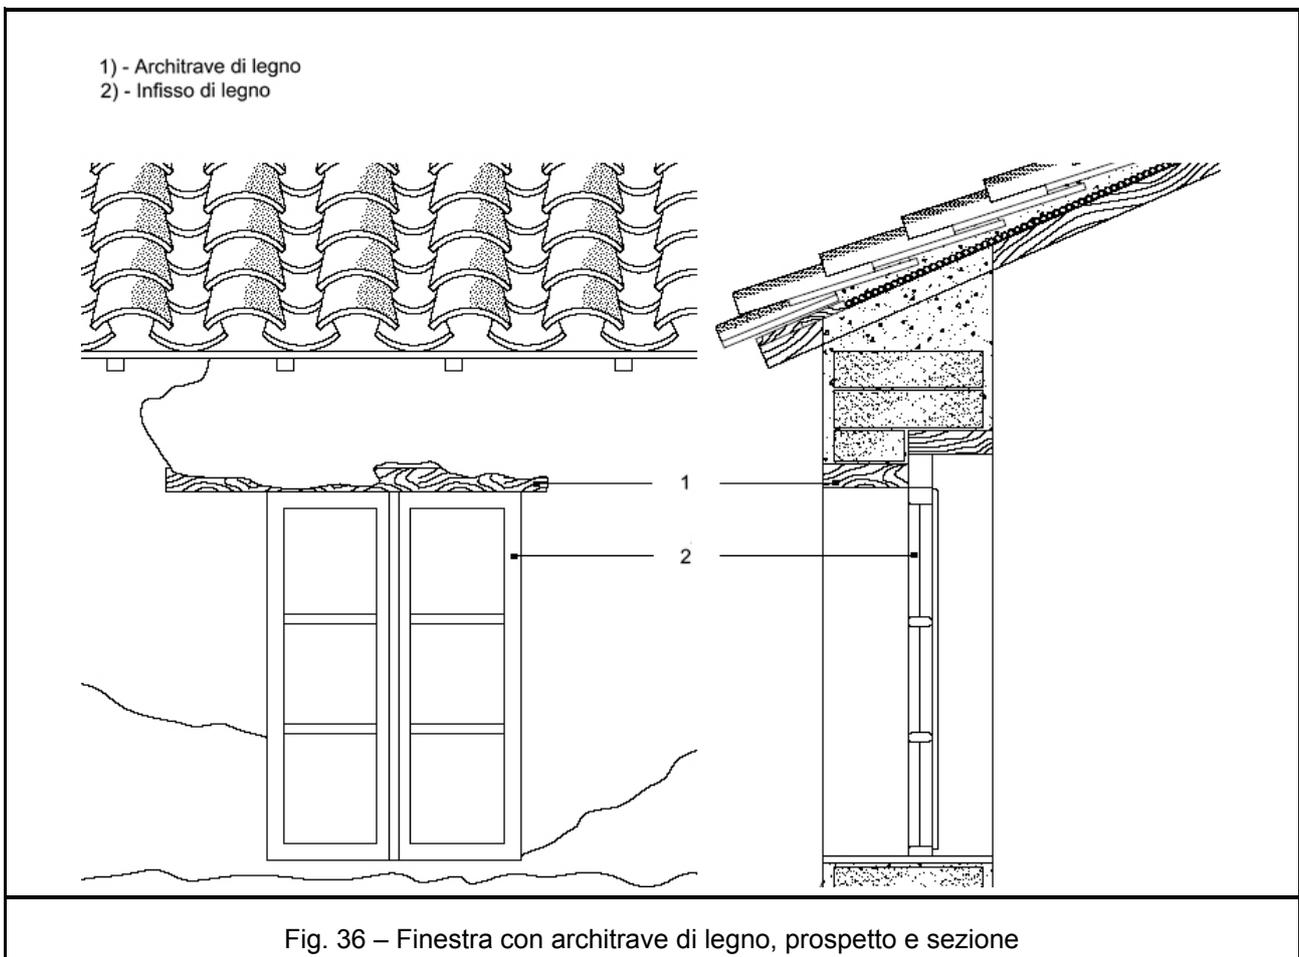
Finestra con architrave di legno, prospetto e sezione
